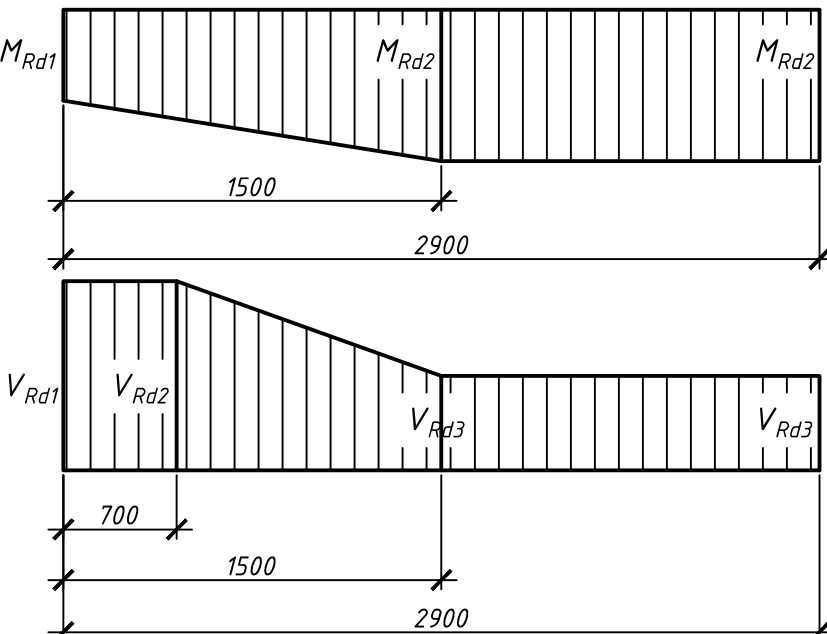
Эпюры предельных усилий для стропильных балок пролетом 6 м
